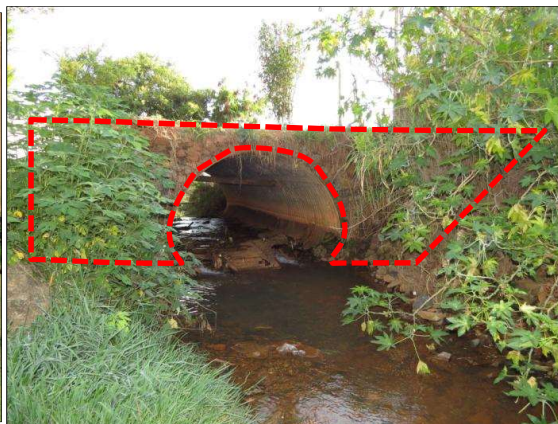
Vista de jusante para montante do tubo metálico e das caixas de gabião (em pontilhado).
